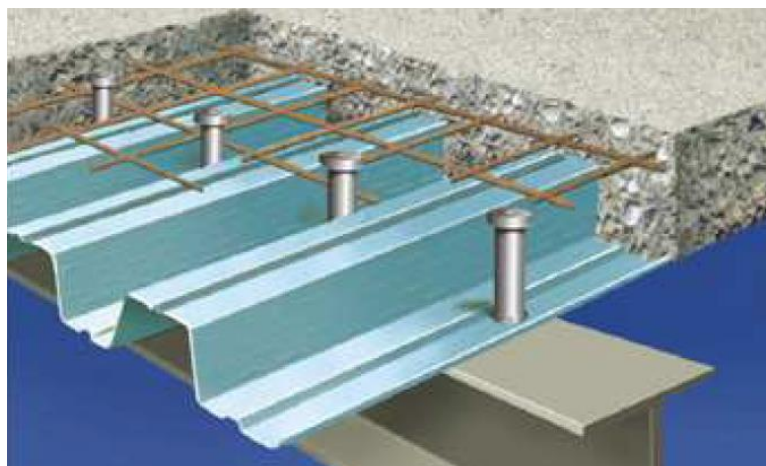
Processo construtivo da laje mista (Figueiredo, 2014)
